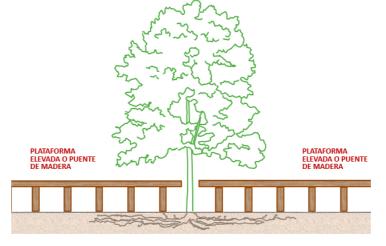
Plataforma de madera elevada. Fuente: Tecnigral
